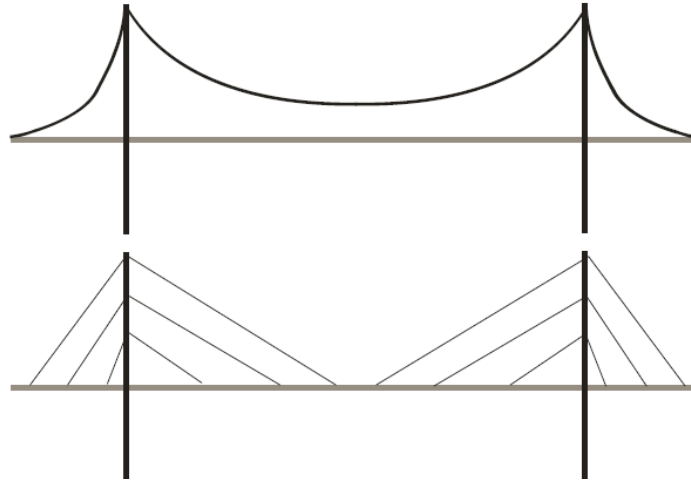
Esquema de puente colgante y puente estabilizado por cables.
